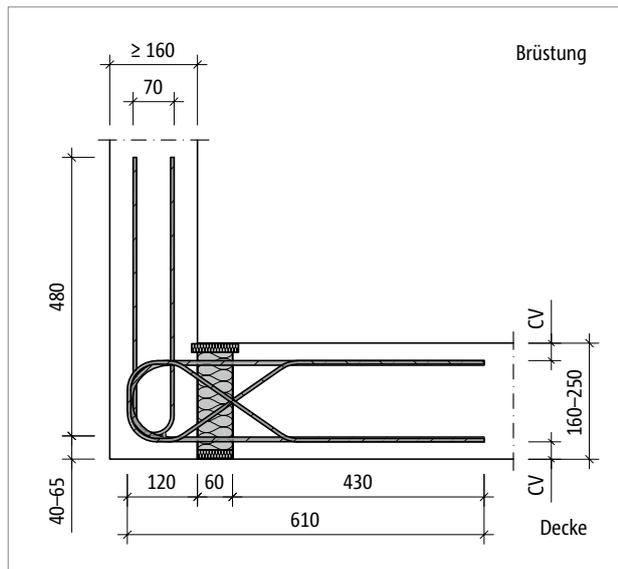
Schöck Isokorb® T Typ F-X60: Produktschnitt
